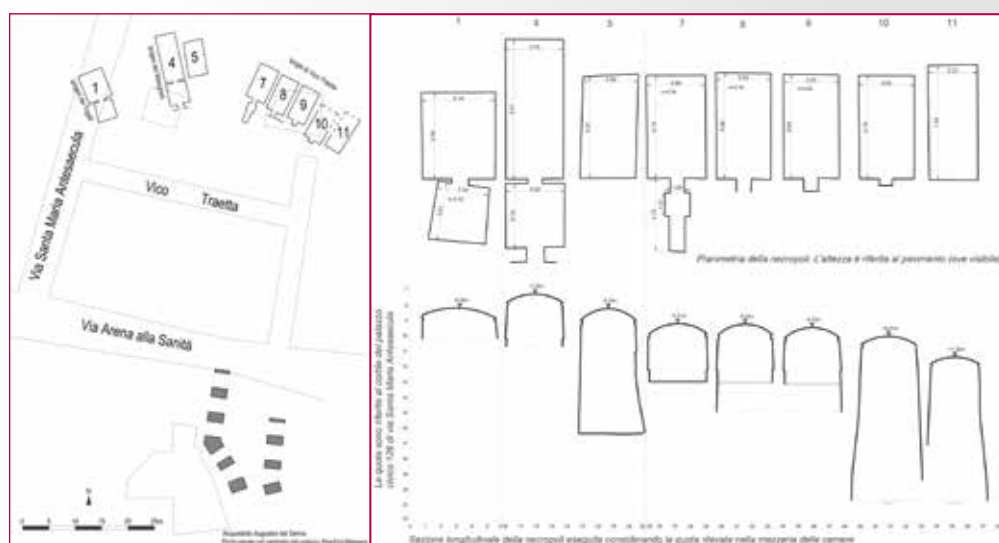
Planimetria dell'area interessata: necropoli ellenistica e ponti-canale dell'acquedotto del Serino (sinistra). Planimetria delle camere indagate e sezione longitudinale del contesto (destra).
